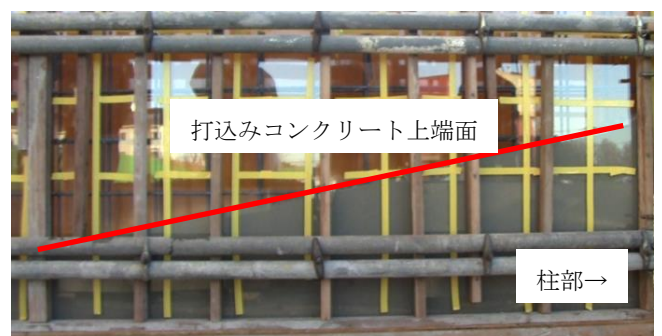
模擬部材打込み状況（スランプ回復コンクリート）
